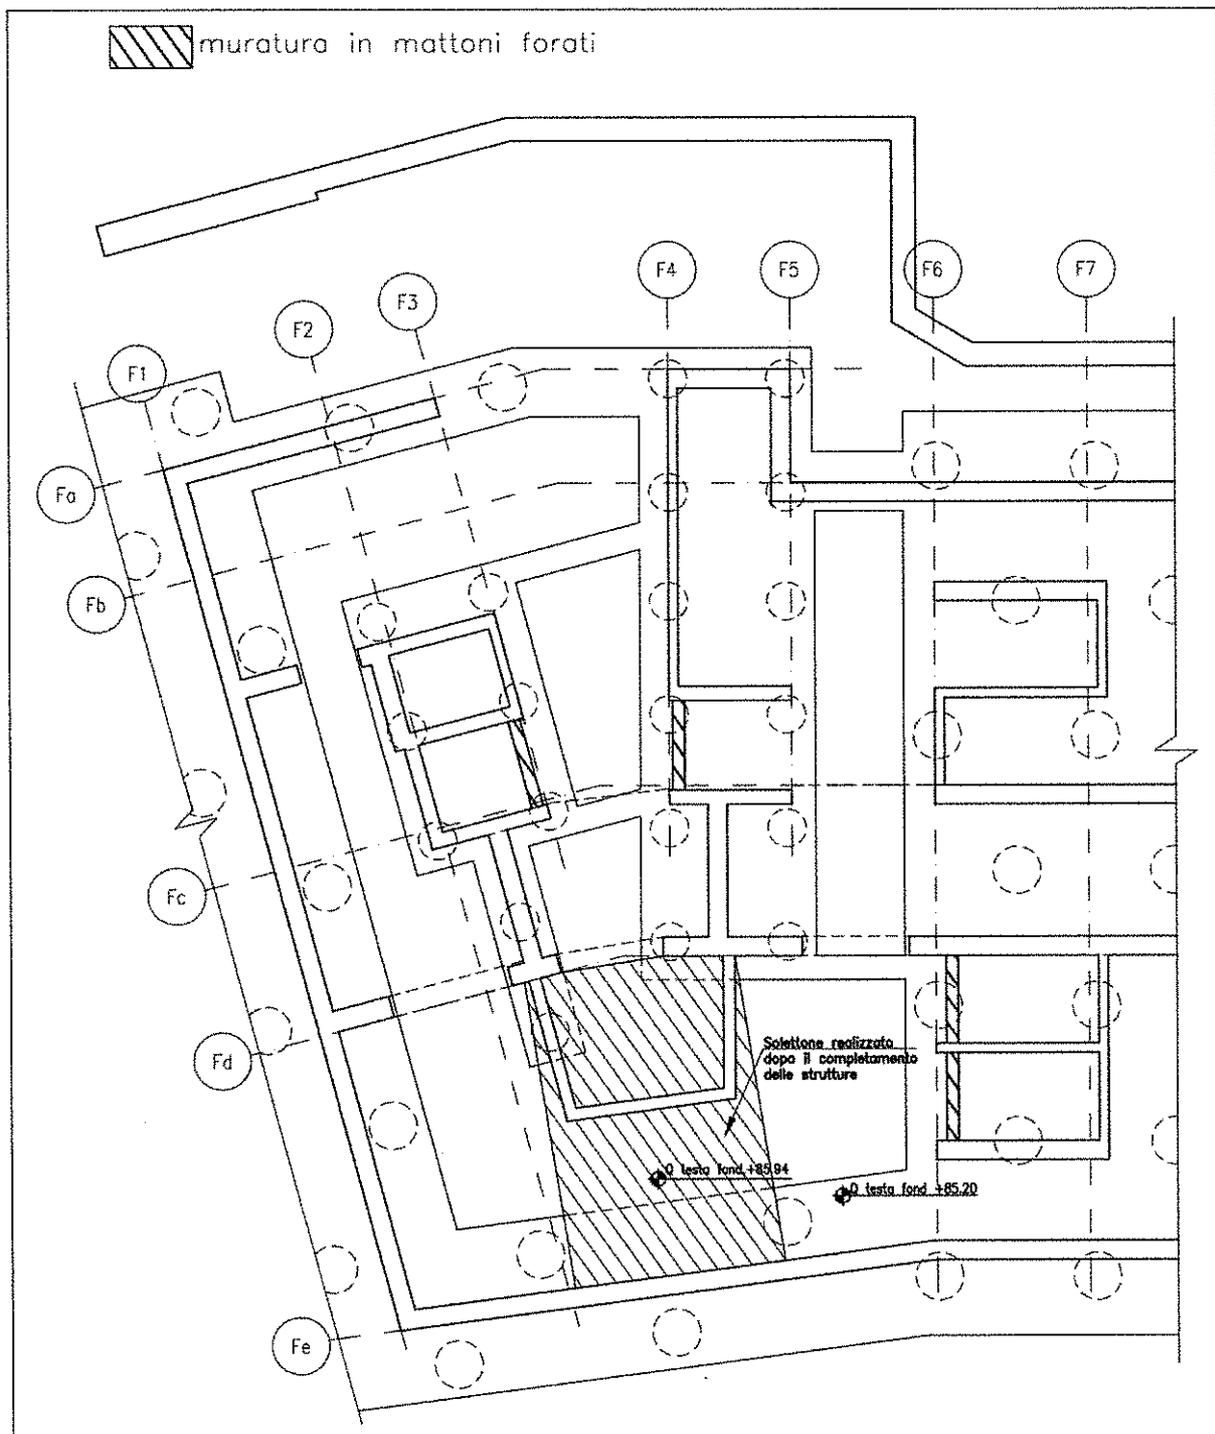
Nodo E-F - Pianta delle fondazioni – Quota 85.20
